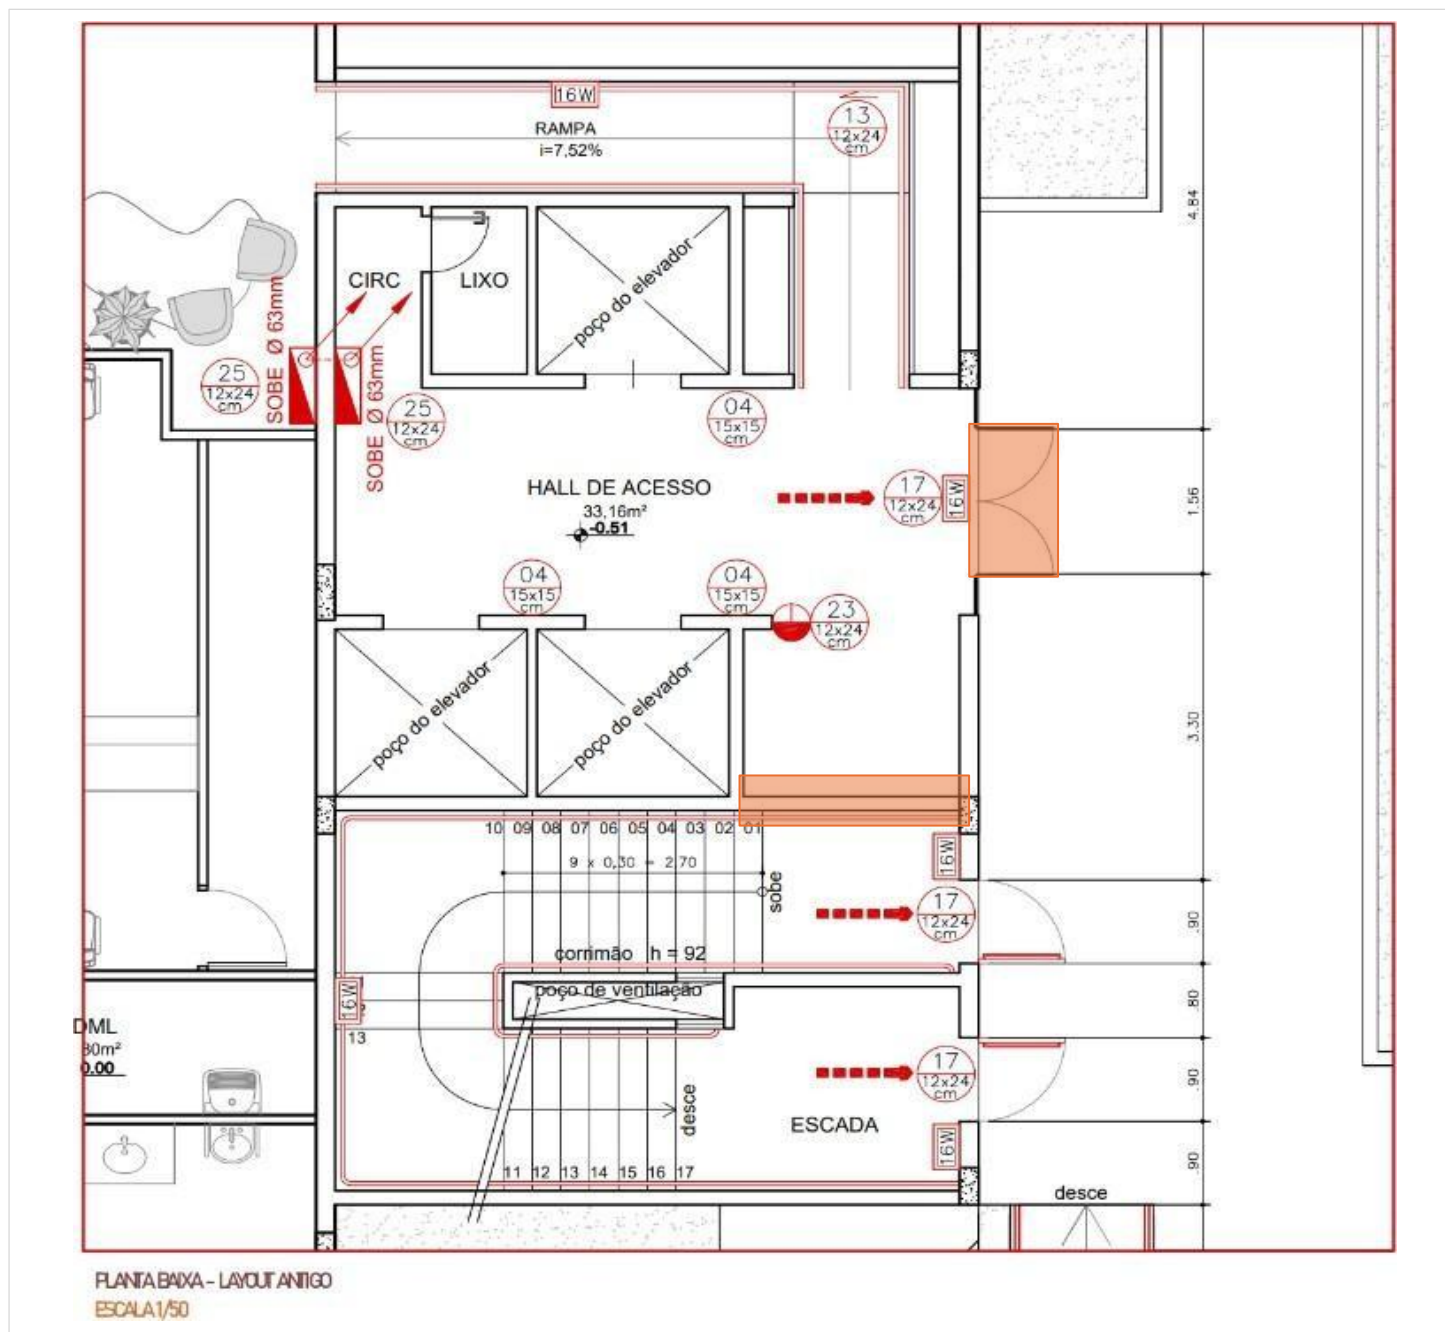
Layout existente com indicação das áreas de demolição e retirada.
